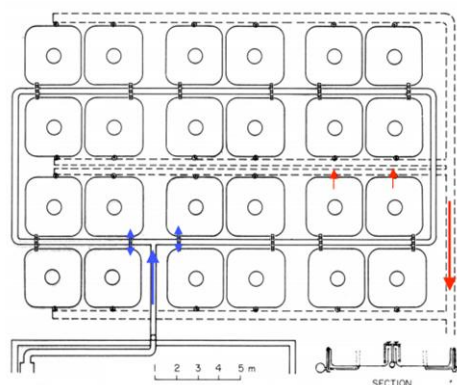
la construction d'un BURROWS<sup>19</sup>
